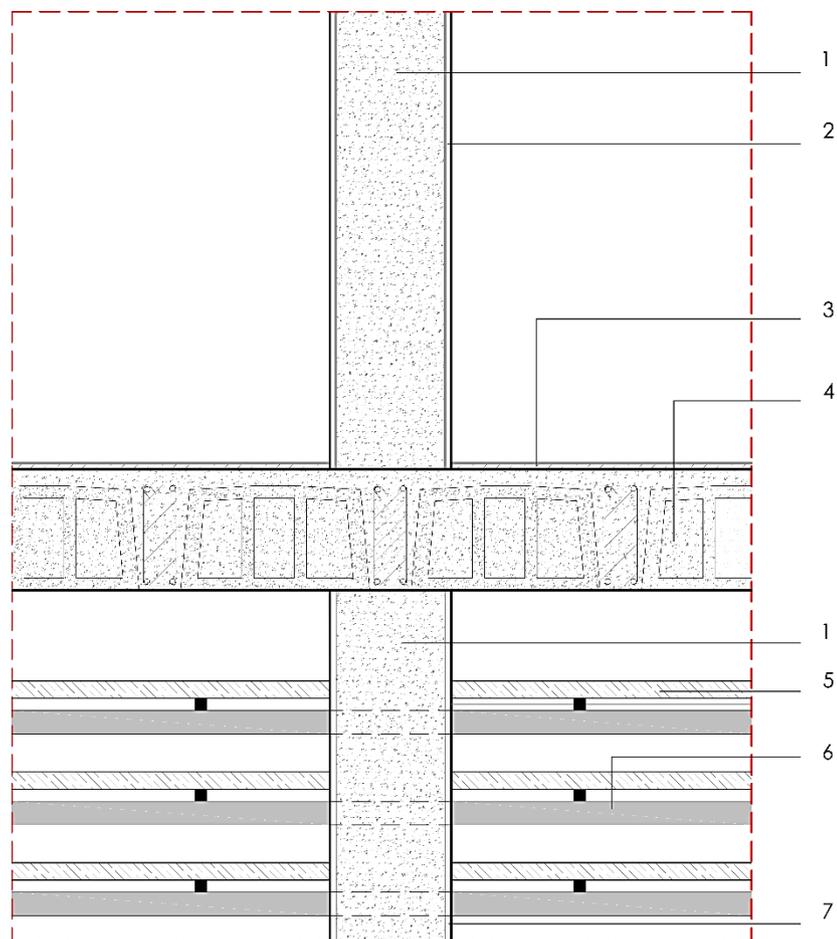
Sección Constructiva 2, Casa Jiguas
